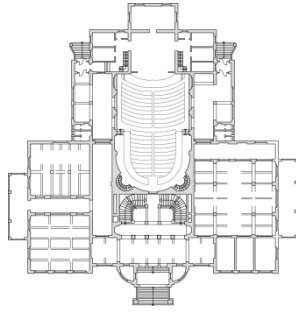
Ankara Adliye Binası Birinci Kat Planı
